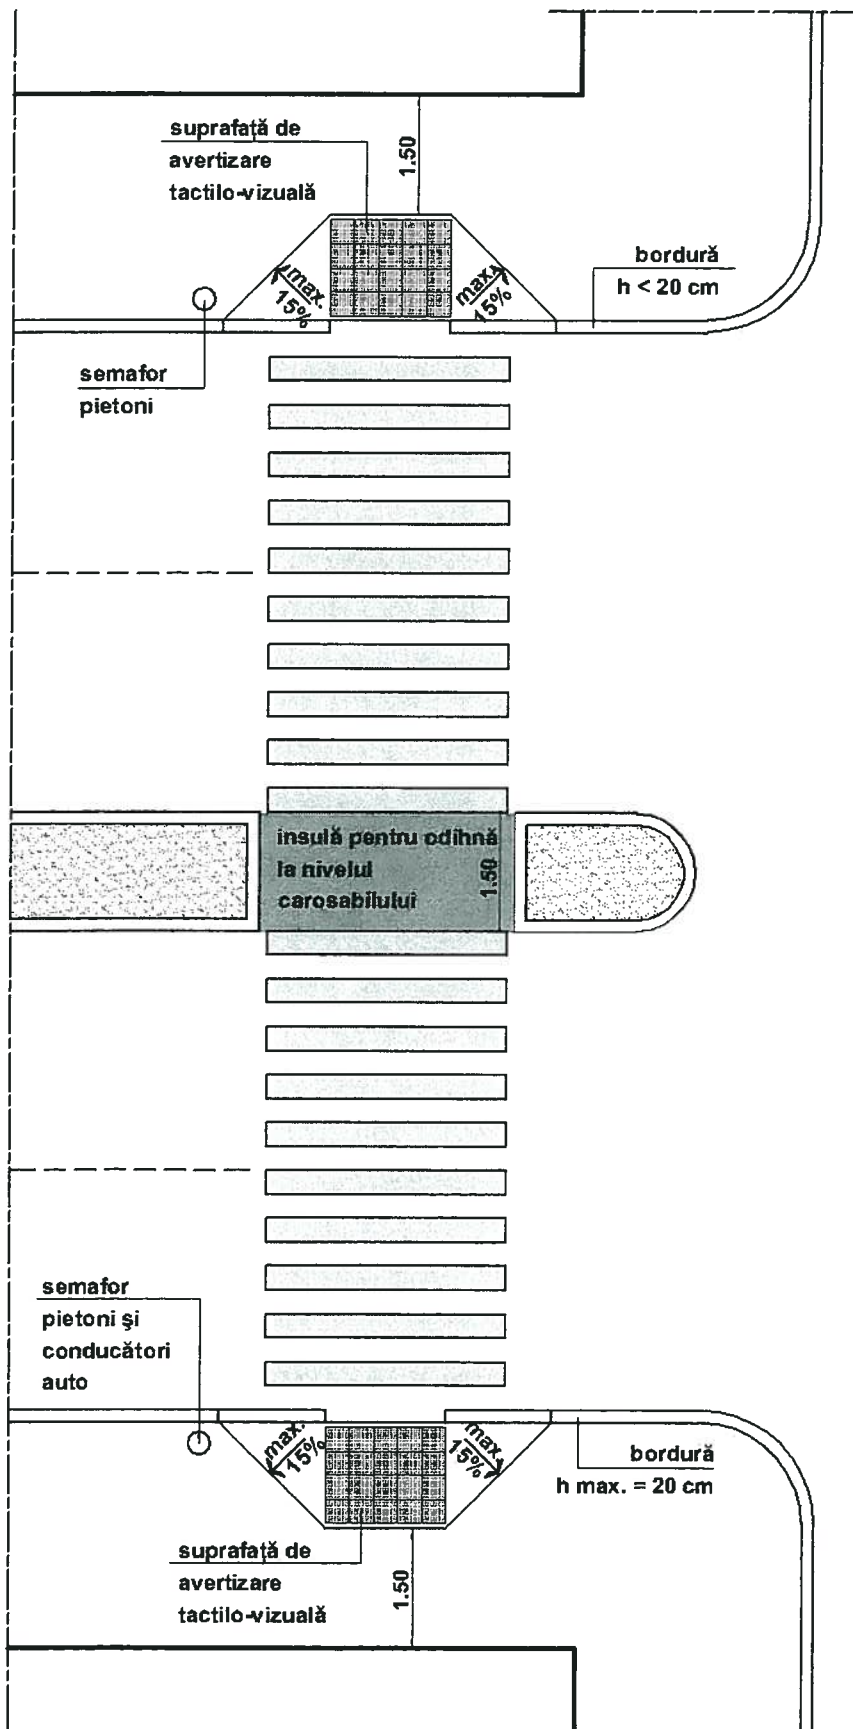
b. – Traversarea străzilor cu lățime mai mare de 4 benzi de circulație. Plan
